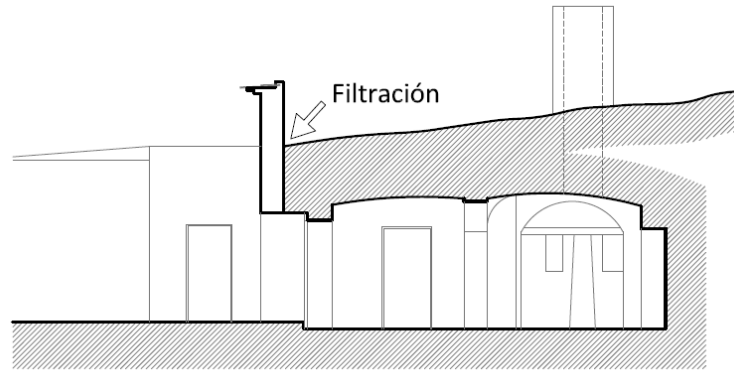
Filtración por cubierta acabada con mortero de cemento.
